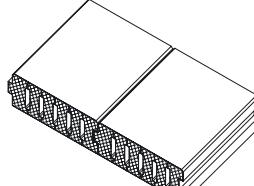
Strop z betonskimi rebri, opečnimi polnili in tlačno ploščo.
